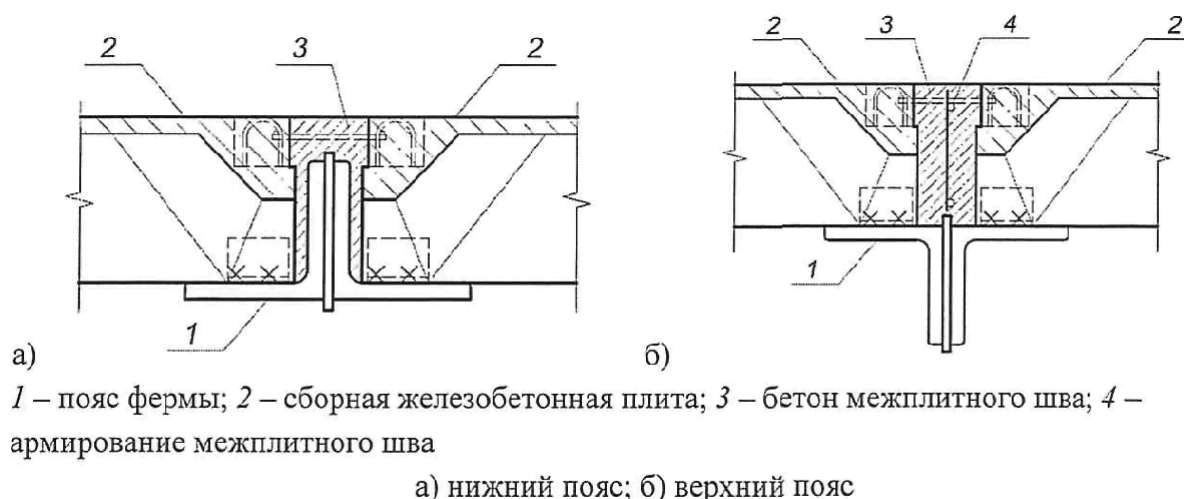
Схема узла сопряжения сборного ребристого перекрытия и поясов ферм
